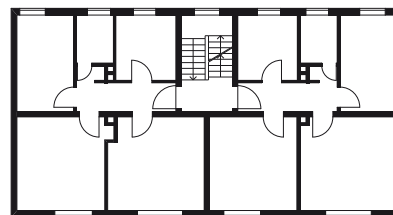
Grundriss als 2-Spänner mit durchgesteckten Wohnungen im 3. Bauabschnitt
